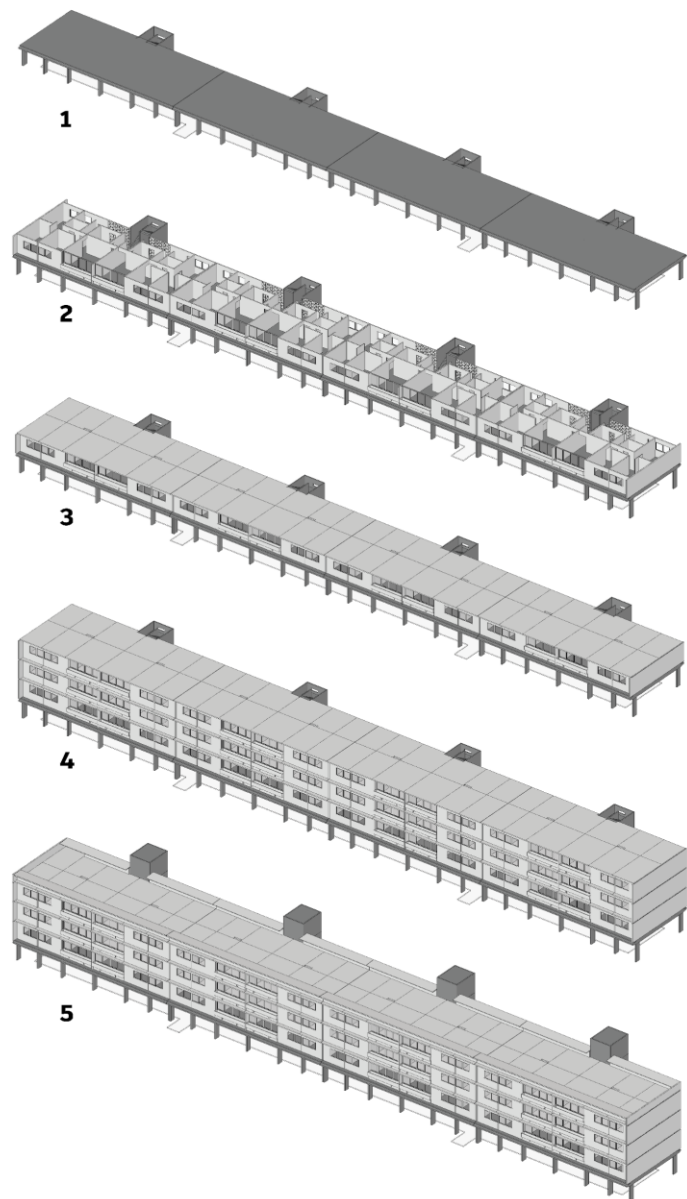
Etapas de construção do bloco R2. Fonte: da autora.
